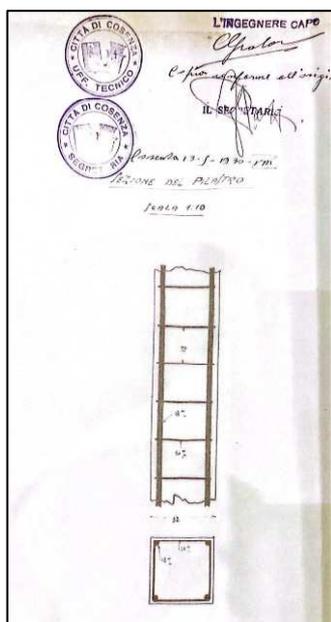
Cosenza. Sezione del pilastro solaio serbatoio acquedotto Merone. Progetto dell'Ingegnere Tommaso Gualano, 1930 – Scala 1:10. Fonte: Archivio di Stato di Cosenza – Genio Civile, rete idrica fognante, busta 135.
